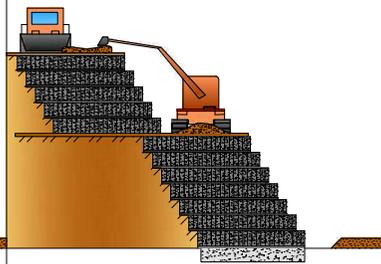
Конструкция армогрунтовой подпорной стенки с применением георешётки "АРМОГРИД".
